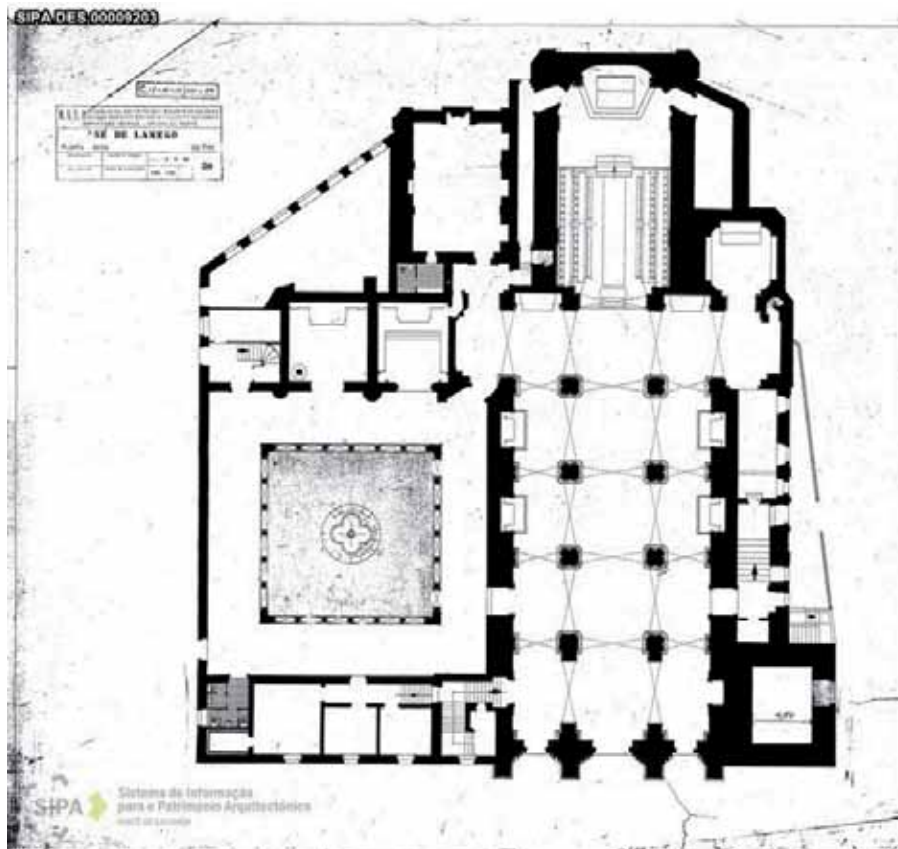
Planta de la Catedral de Lamego. IHRU
